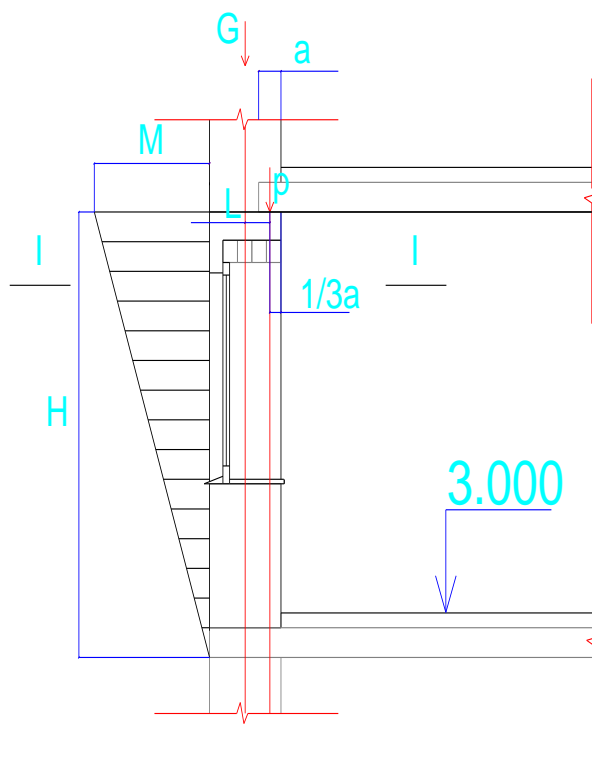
Схема прикладених навантажень на несучу стіну, та епюра згинального моменту  $M$
